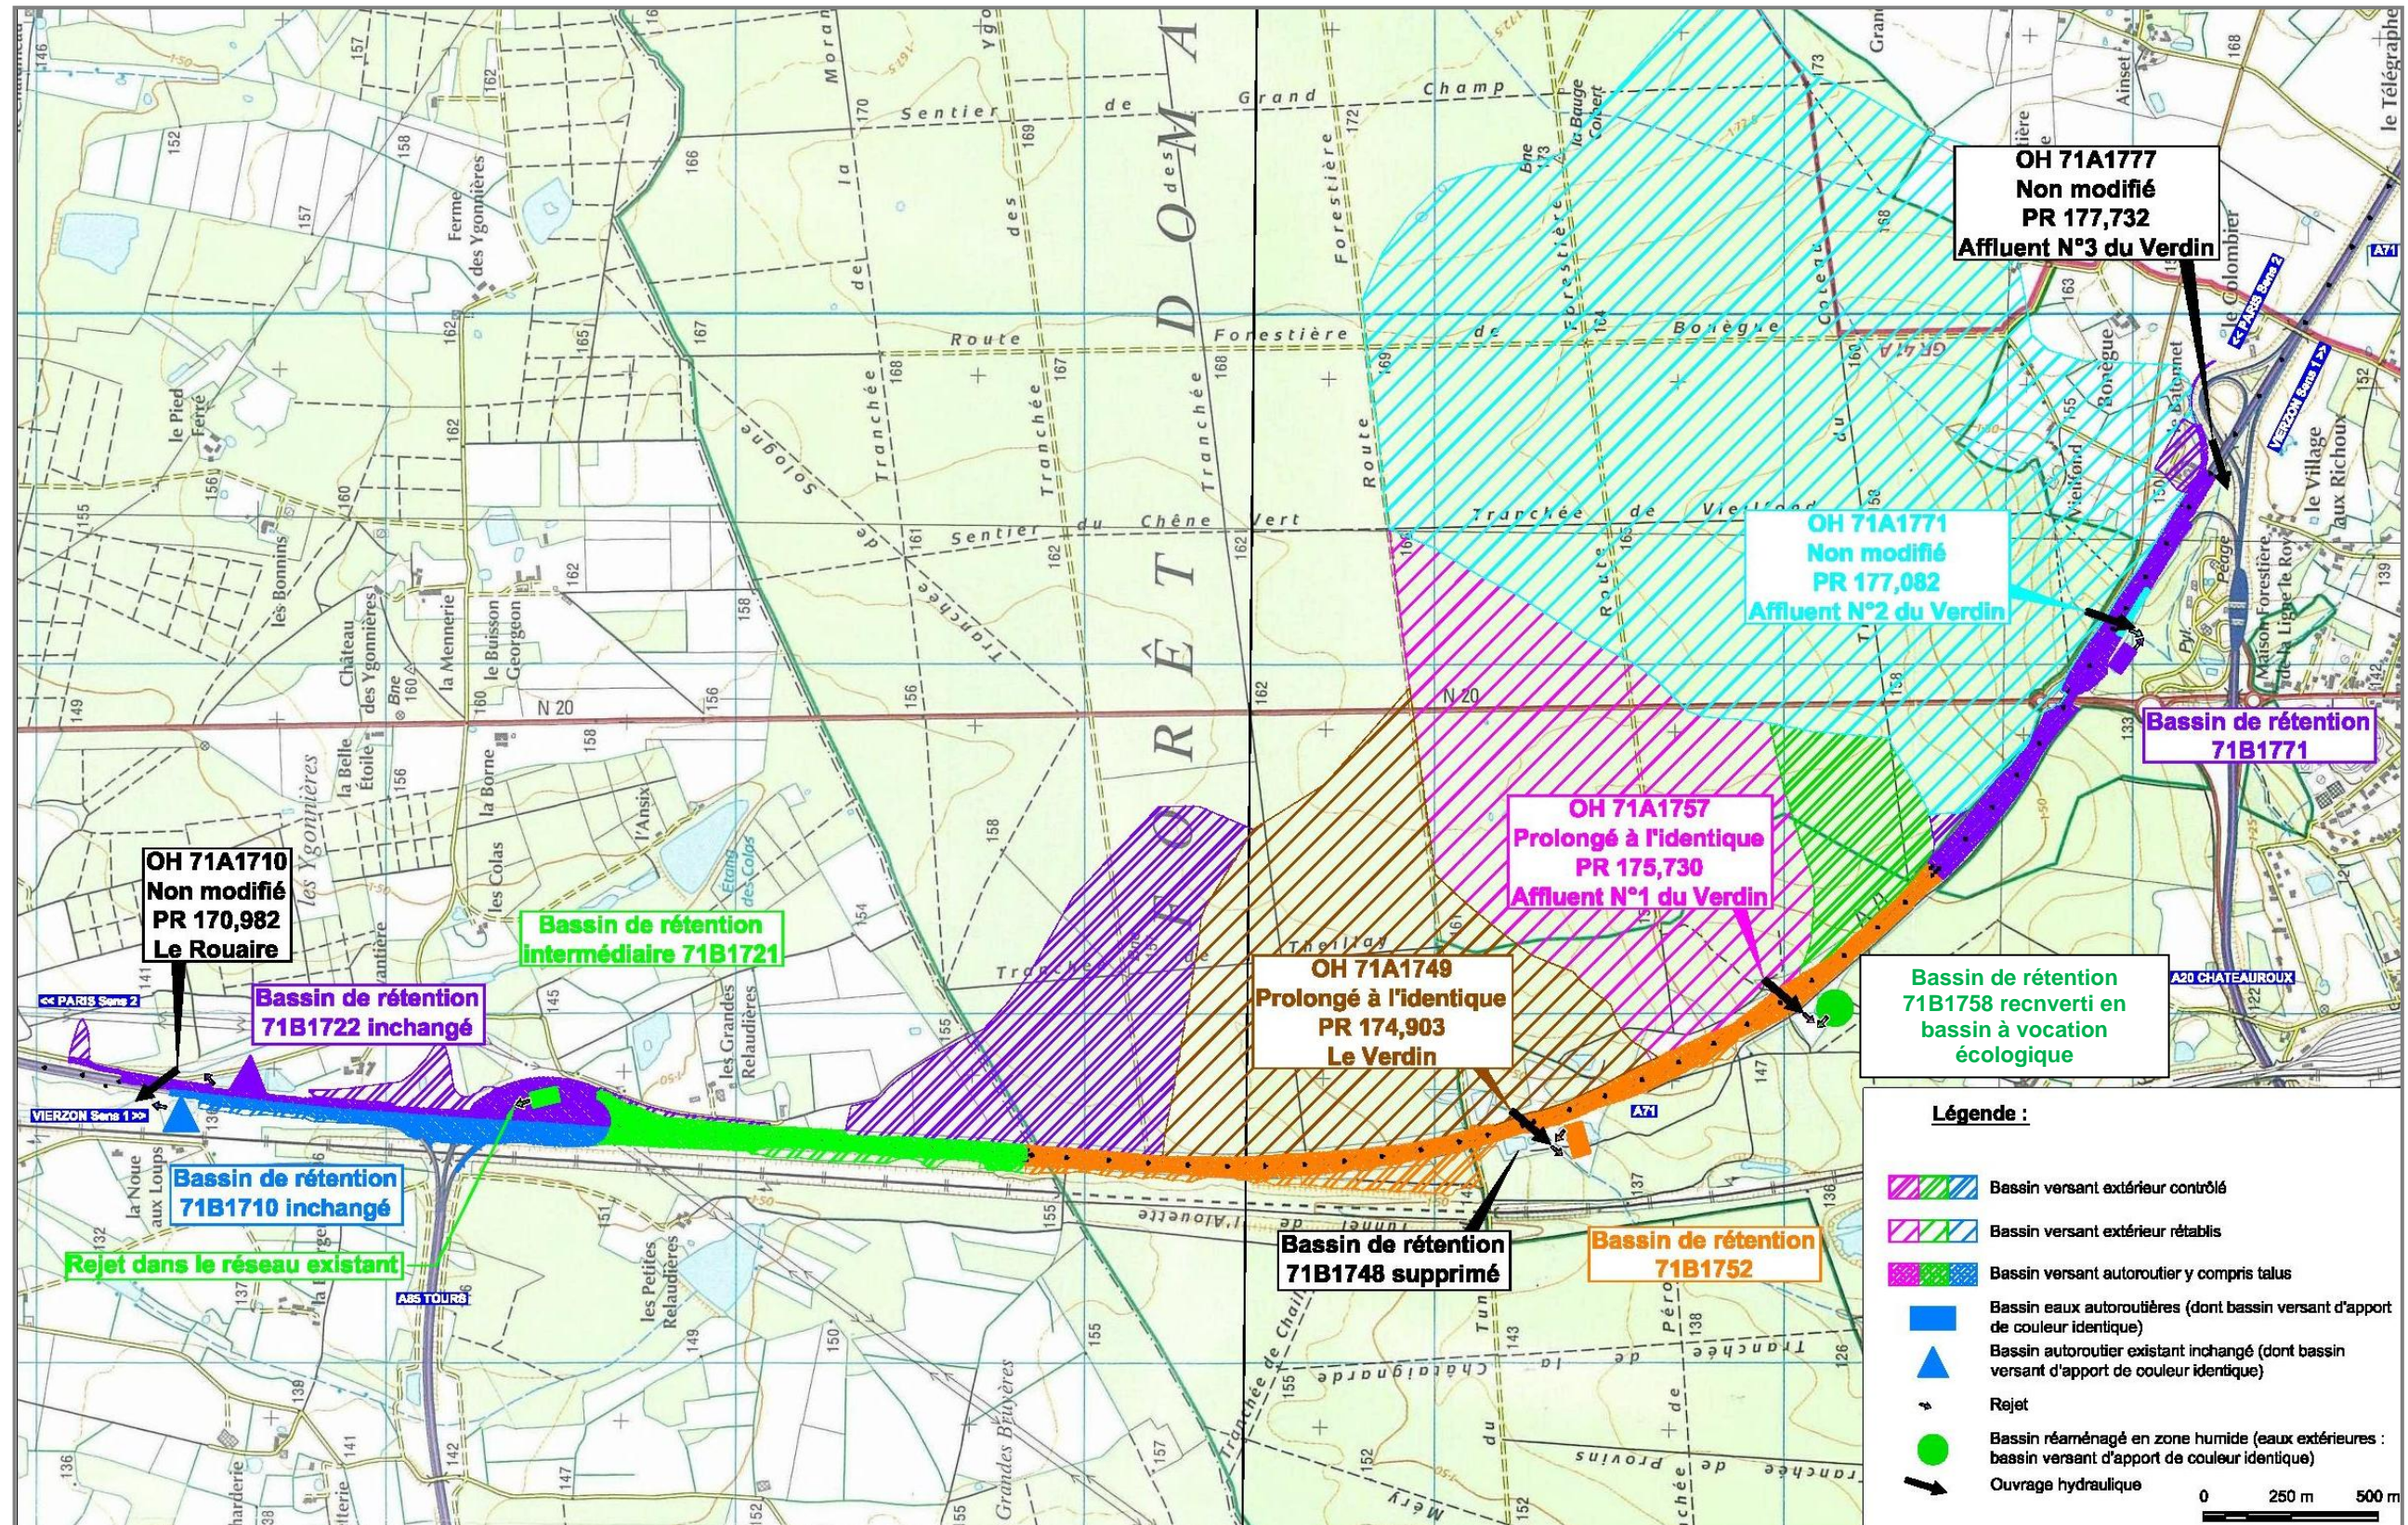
Schéma de principe de l'assainissement pluvial – Situation projet
